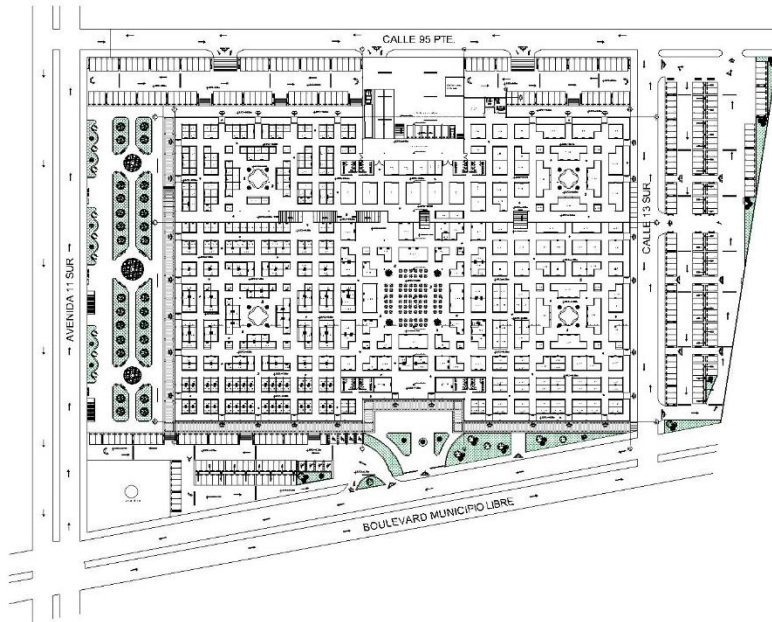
Planta de conjunto arquitectónica Mercado Independencia
